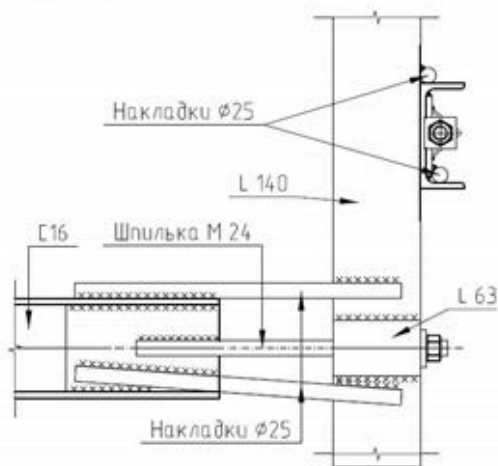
Постановка накладок усиления стены (накладки из арматуры диаметром 25 мм привариваются после создания предварительного напряжения тяжей болтовыми соединениями)
